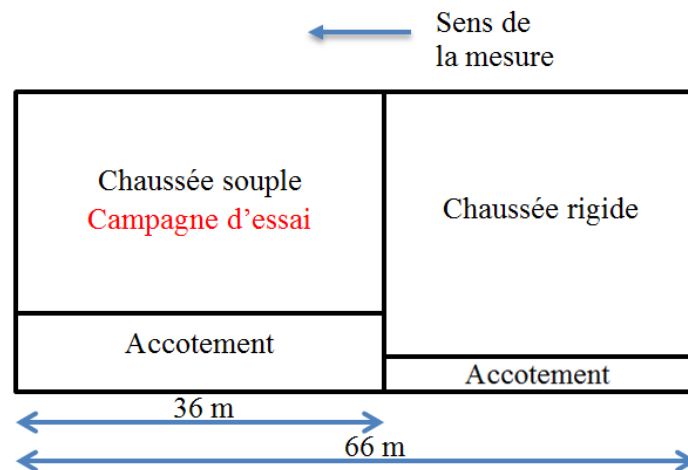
Dimensions de la planche instrumentée du STAC.
